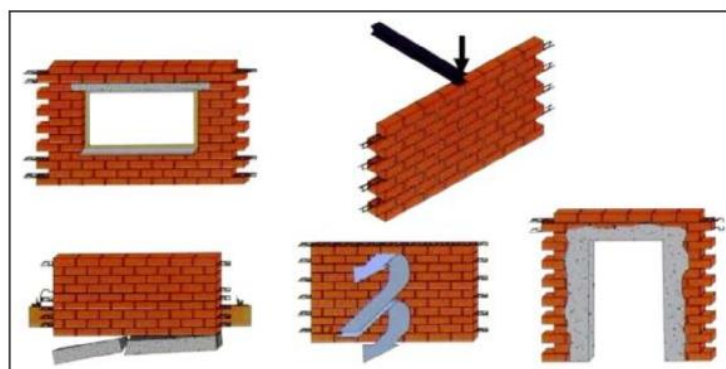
Exemplos de colocação de armadura localizada em paredes de alvenaria [27]
